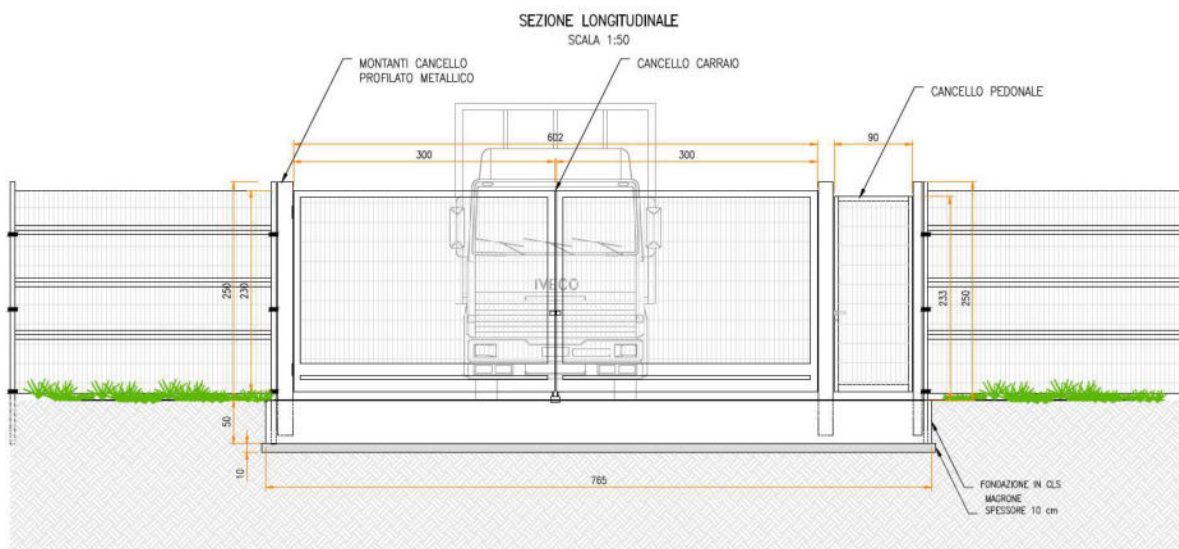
Sezione longitudinale accesso carraio e pedonale
